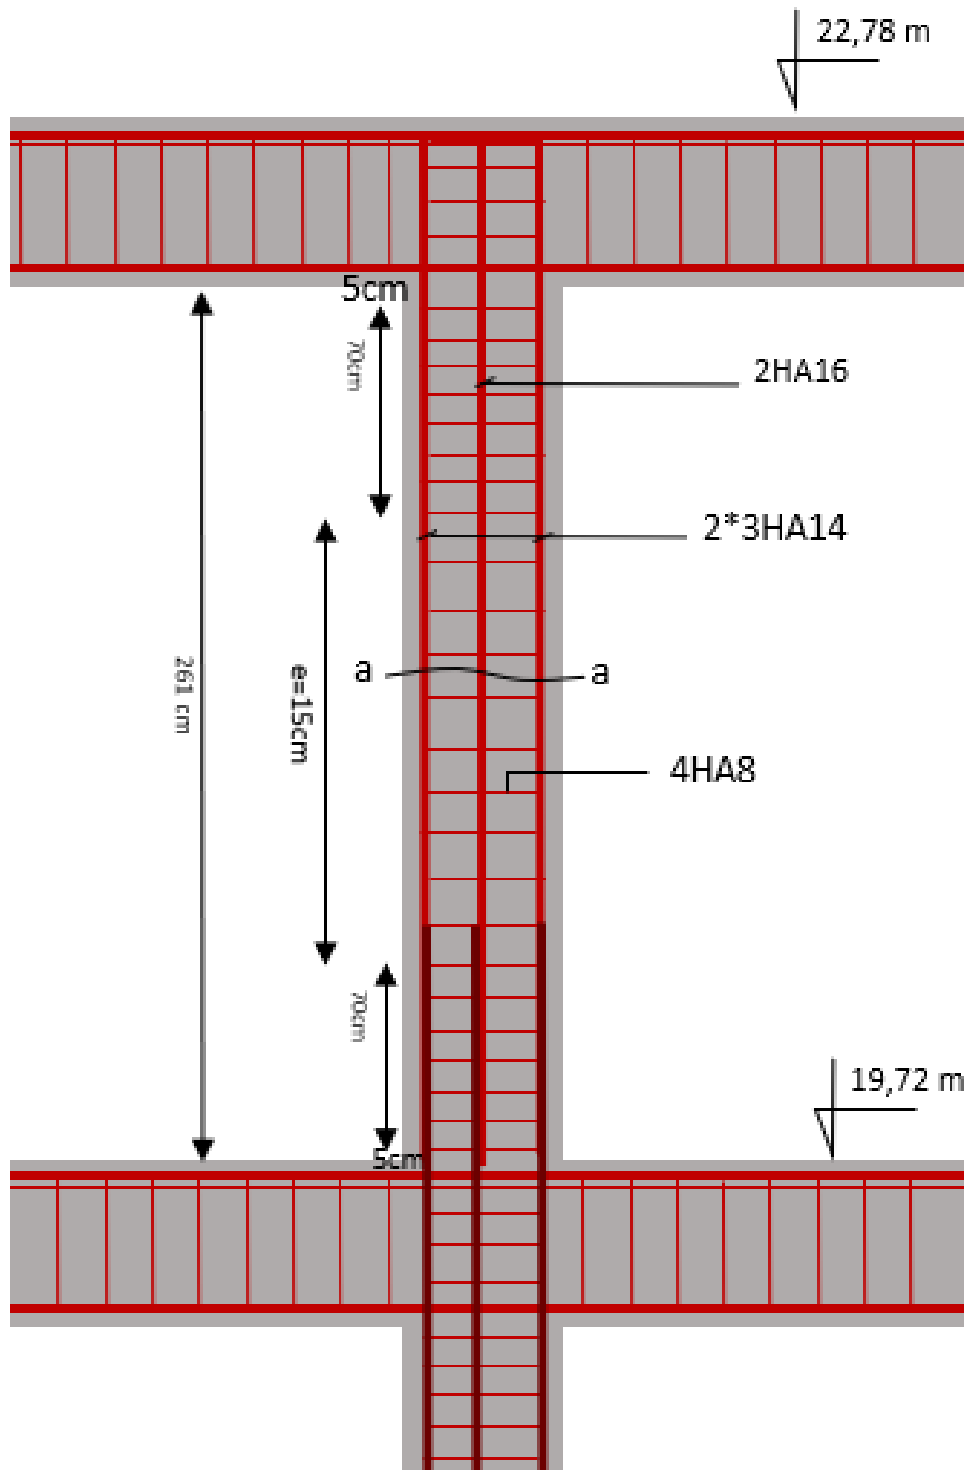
Schéma de ferrailage des poteaux 35*40cm avec poutre principale
